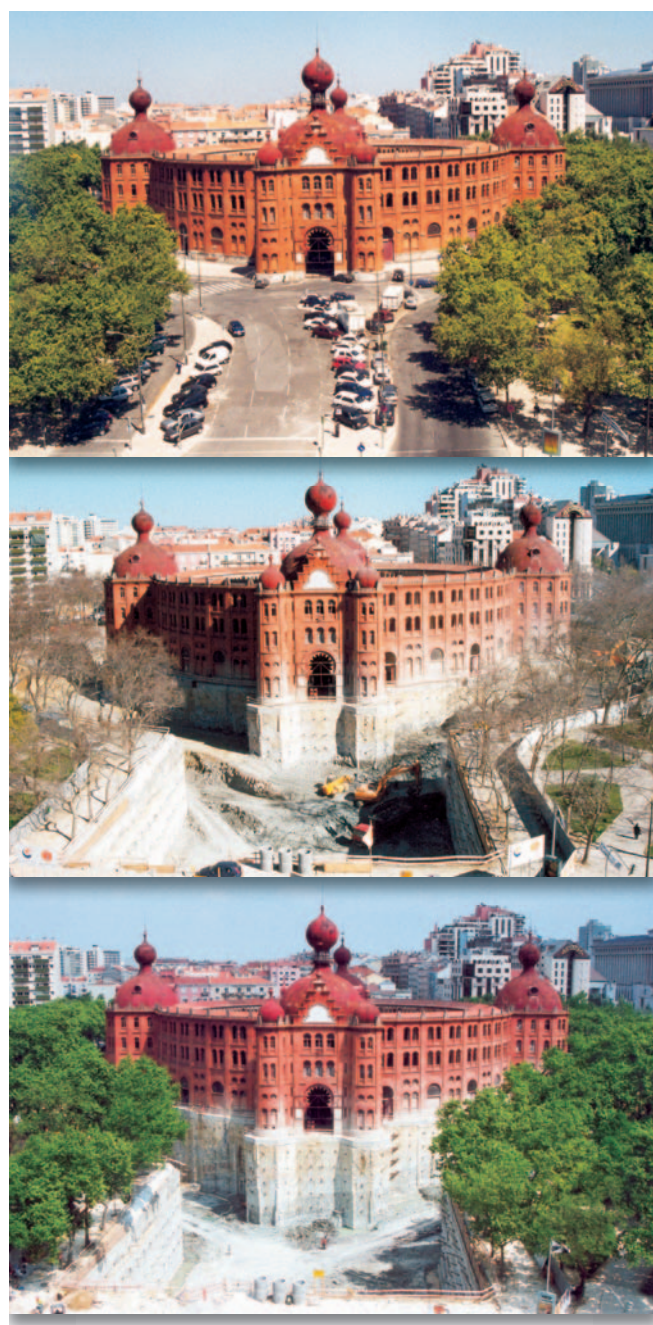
Perspectiva do faseamento de escavação no alçado principal
